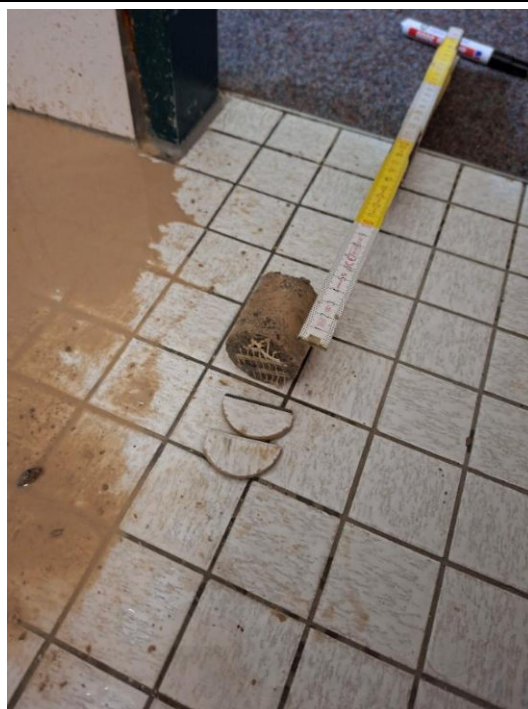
EGB2 Fliese + Estrich mit Gewebe
